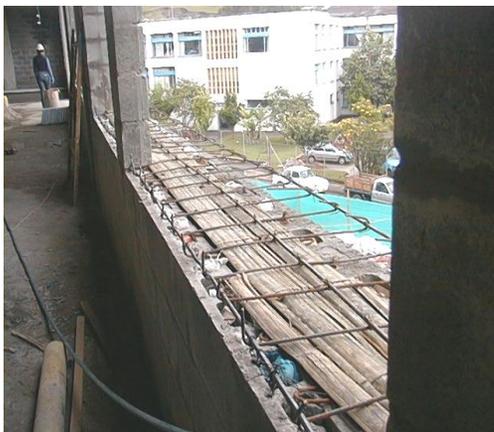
Detalle acero de refuerzo alfajía de 6 cm.
